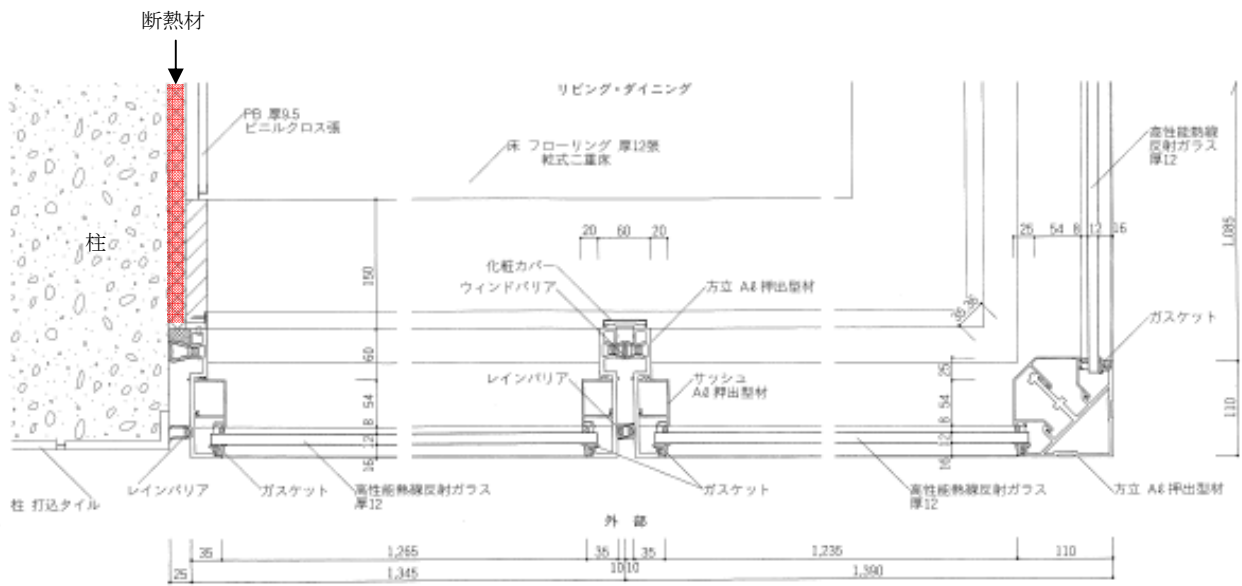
TOKYO TIMES TOWER図面（平面詳細）
